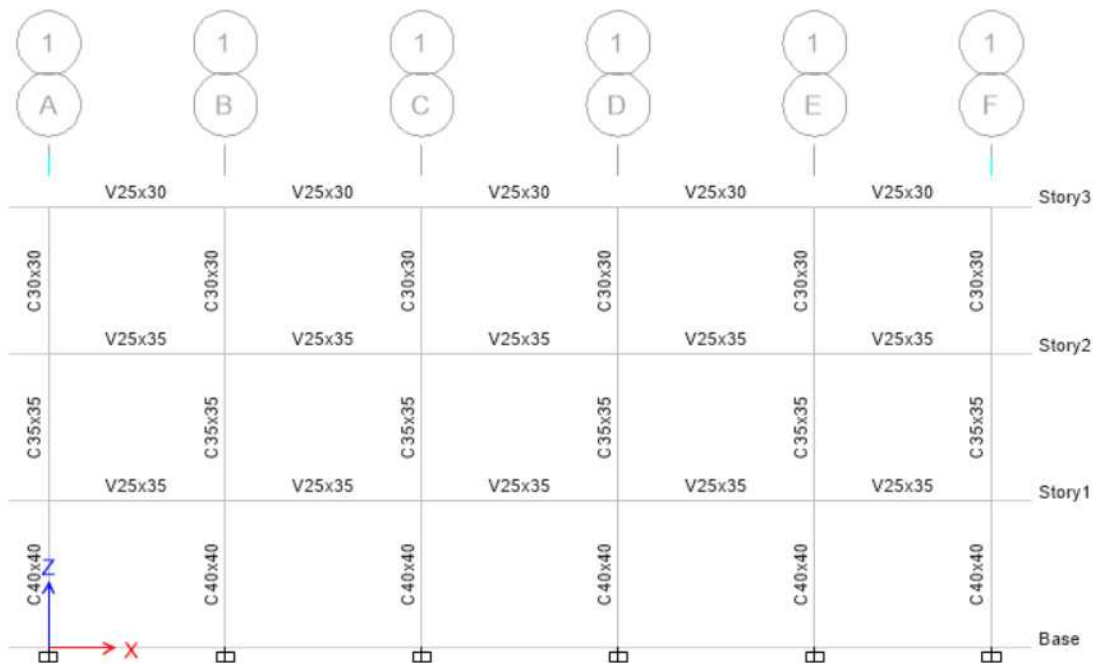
Vista lateral del sistema estructural – 3P - SMF
